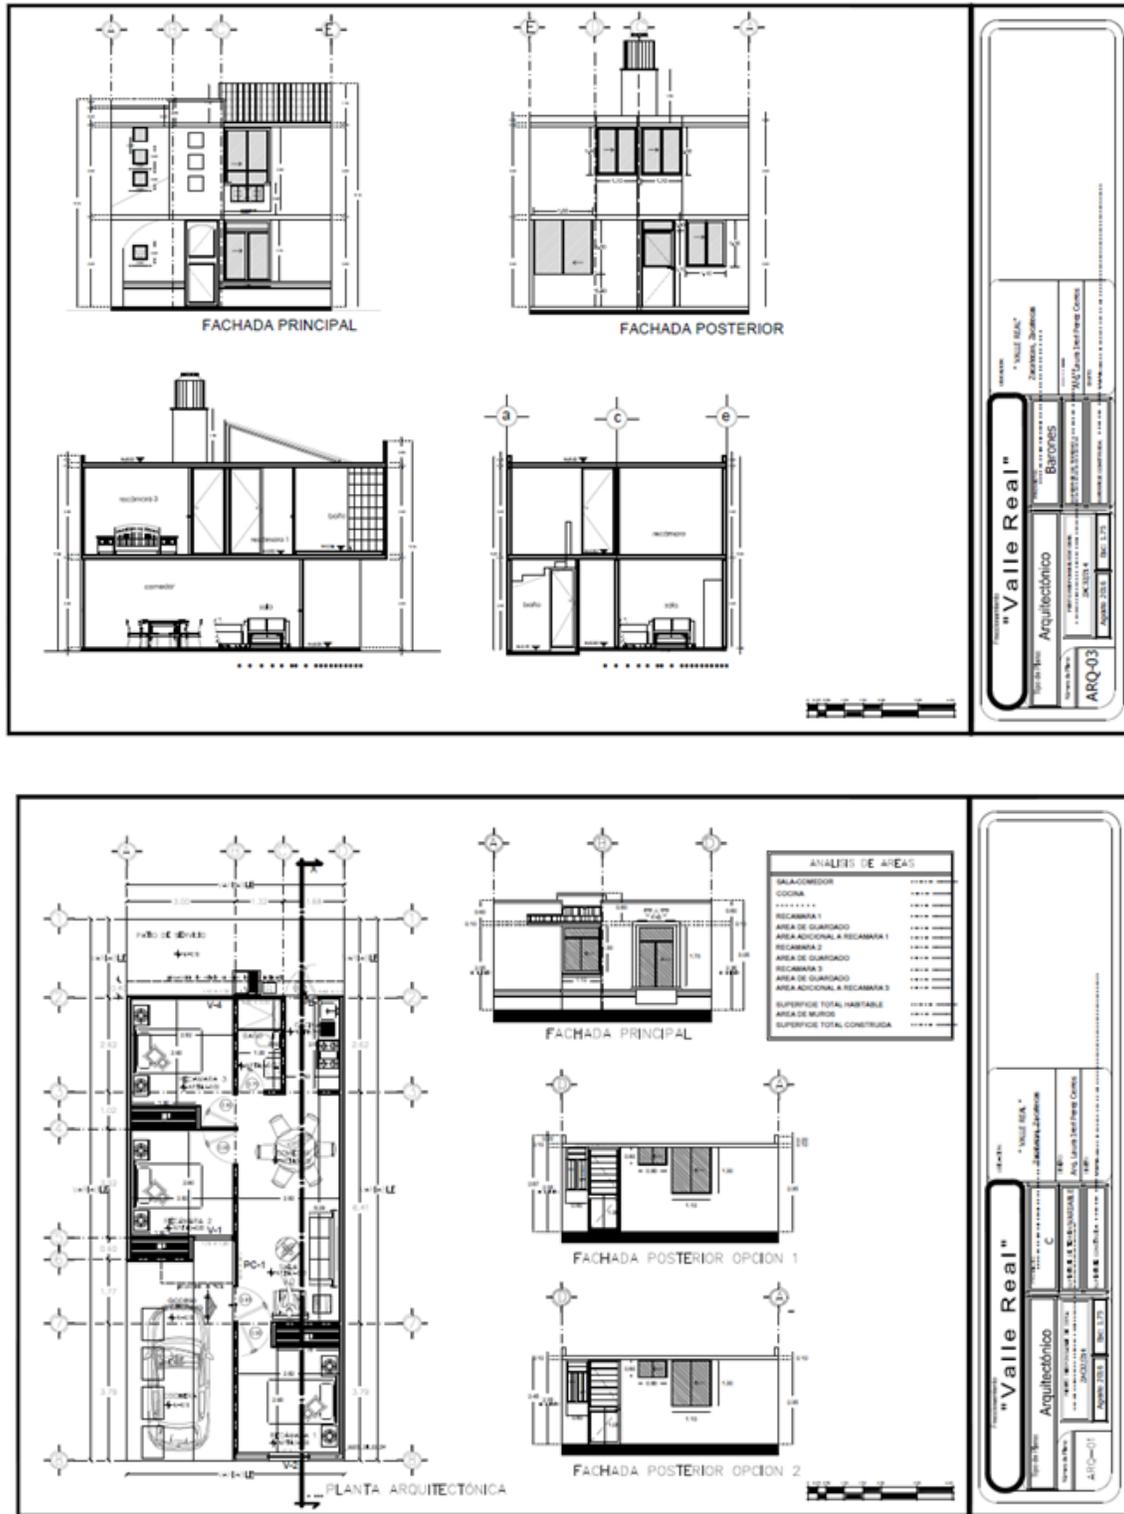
y19.- Planos Arquitectónicos de Casas tipo
